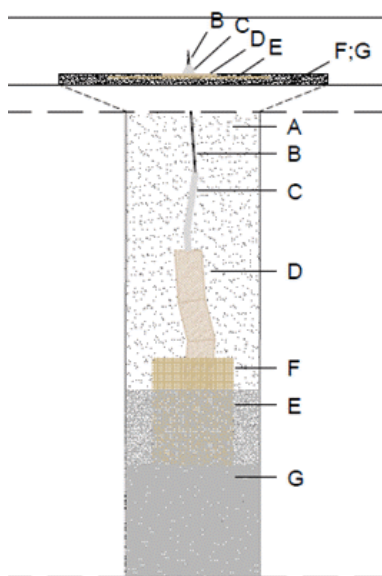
Esquema de reparação de fissuras [43]
